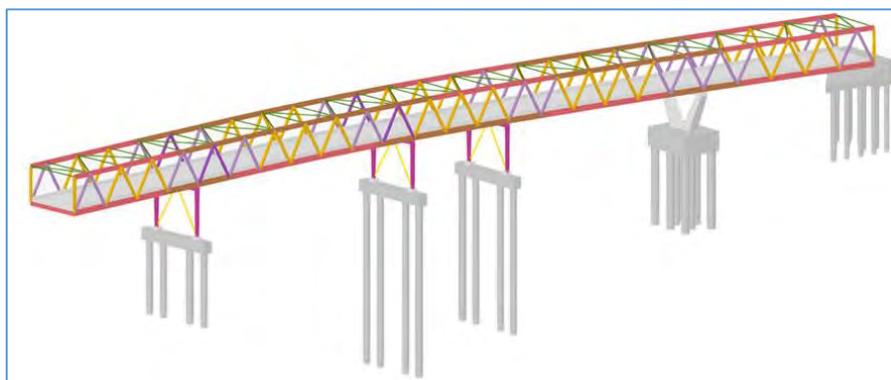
Vista tridimensional da estrutura do Viaduto isolado
